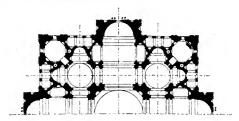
Bramante's Plan für St. Peter in Rom. (Nach A. Thiersch in Durm, Handb. d. Archit.)
